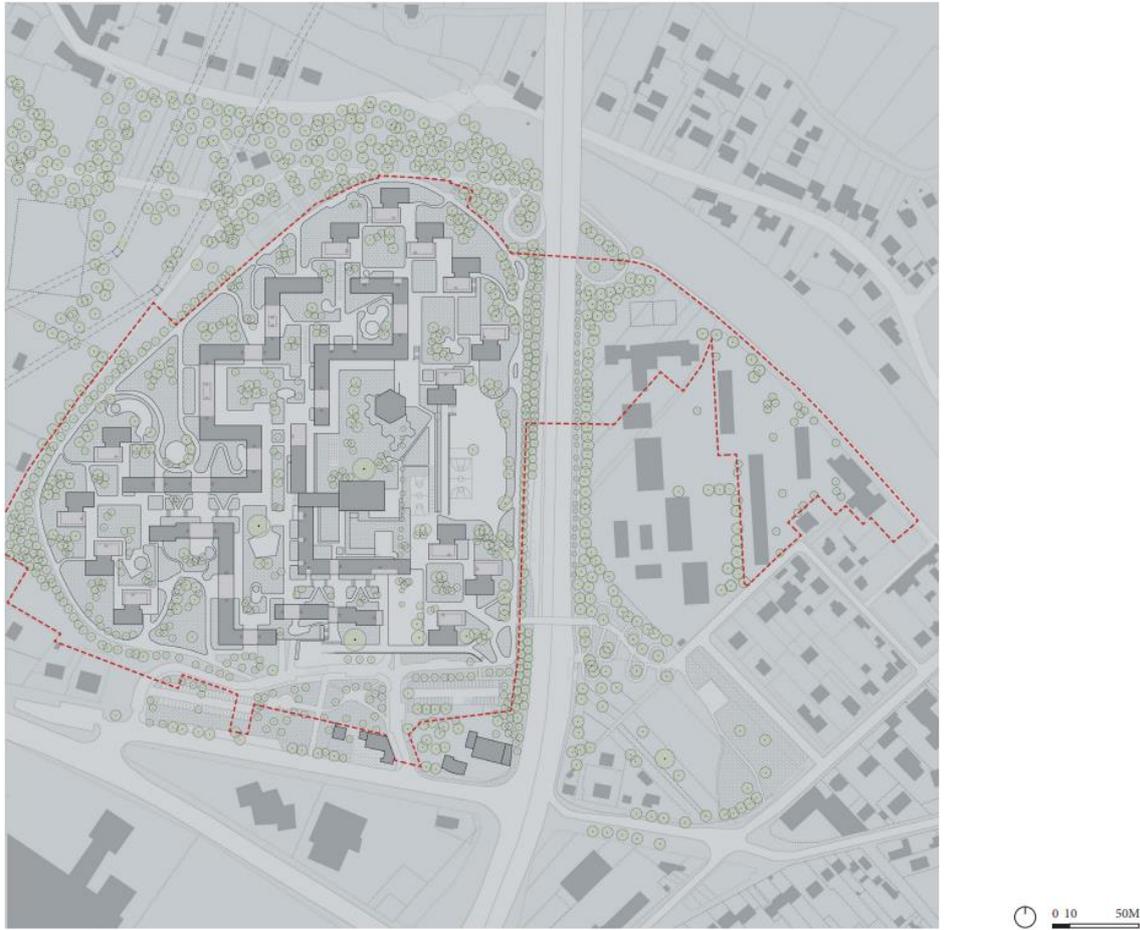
Plan de masse du projet (source : Architects Building for Capacity)
